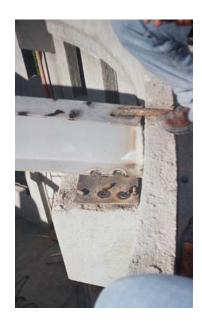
Montaje completo de las cerchas en el Bloque Circular
